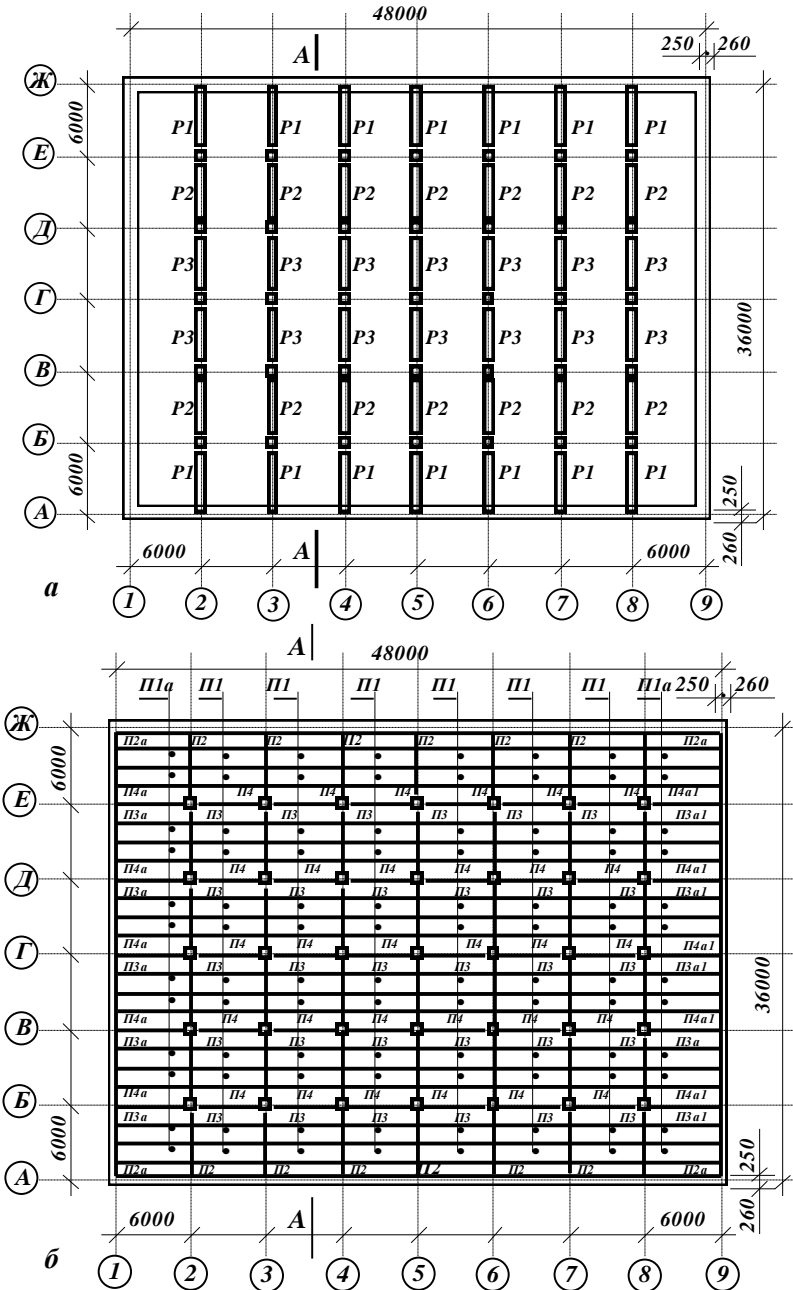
Монтажные схемы ригелей (а) и плит перекрытия (б) первого поверху
